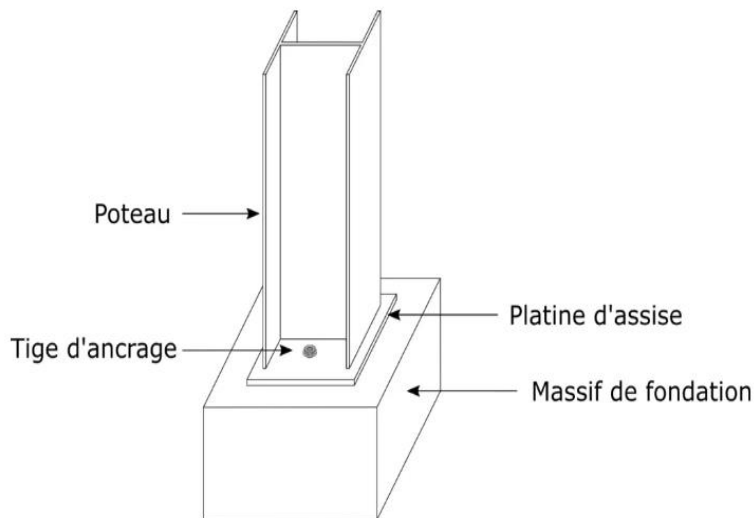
COUPE D'ENCRAGE D'UN POTEAU METALLIQUE
